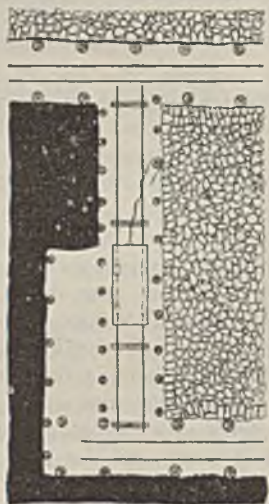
Fördereinrichtung vor Ort. Grundriß.
